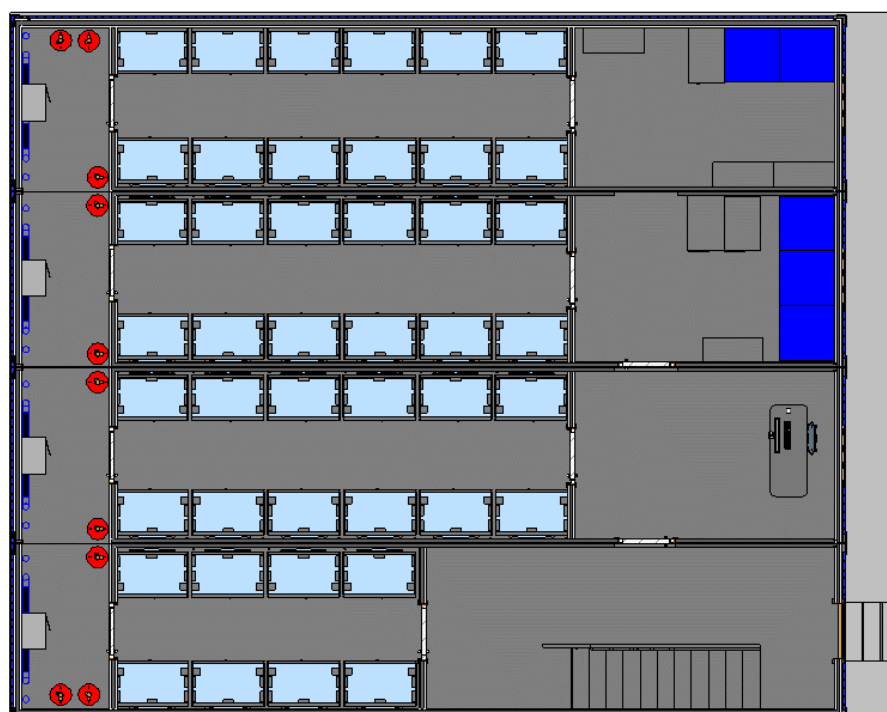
План ИМЭМГ 1-го этажа
